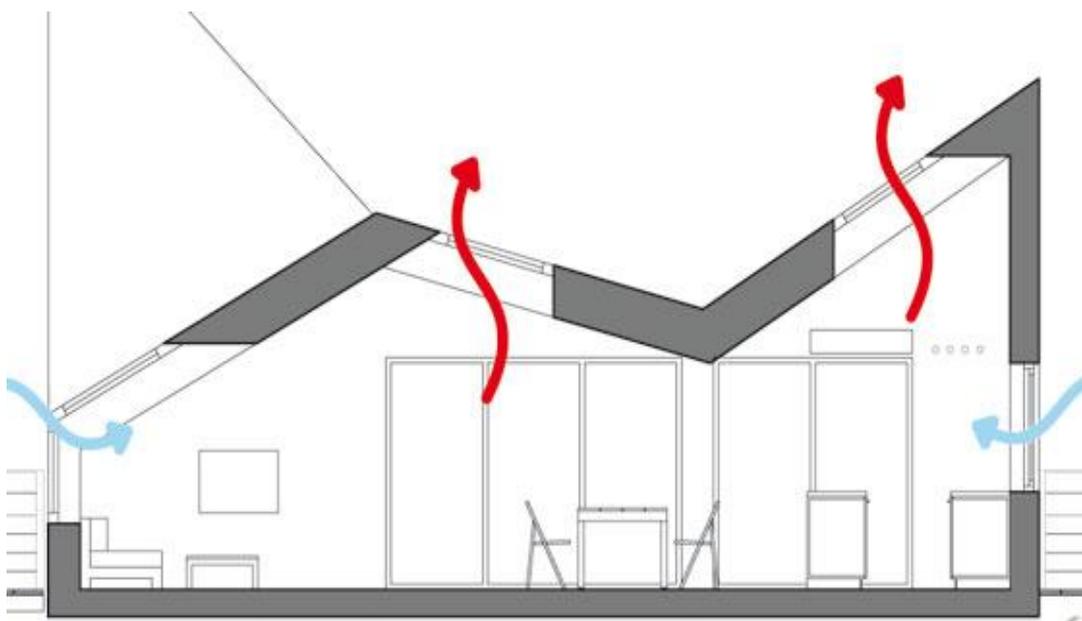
Schema dei flussi nella ventilazione verticale (a camino)
